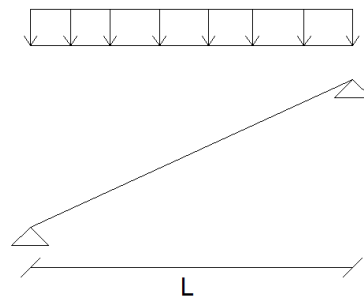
Modelos bi-apoiado para pré-dimensionamento da laje das escadas E2 e E3.
